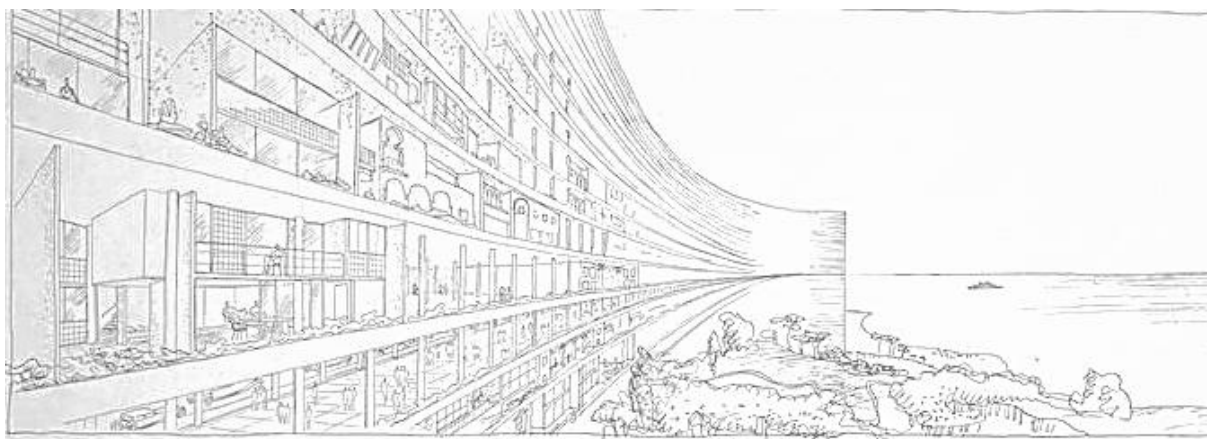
Plan Obus A : perspective sur la façade de l'immeuble-autoroute
